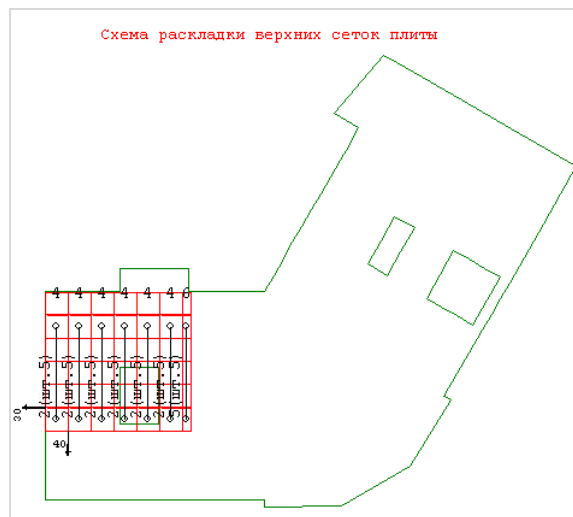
Схема раскладки сеток у верхней грани плиты, участок 2 (фрагмент)
